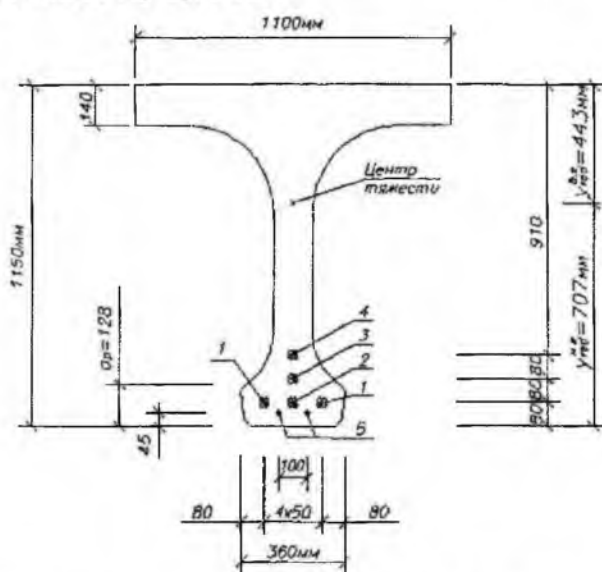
Поперечное сечение балки ВТК-24У в середине пролета без накладной плиты и швов омоноличивания;
